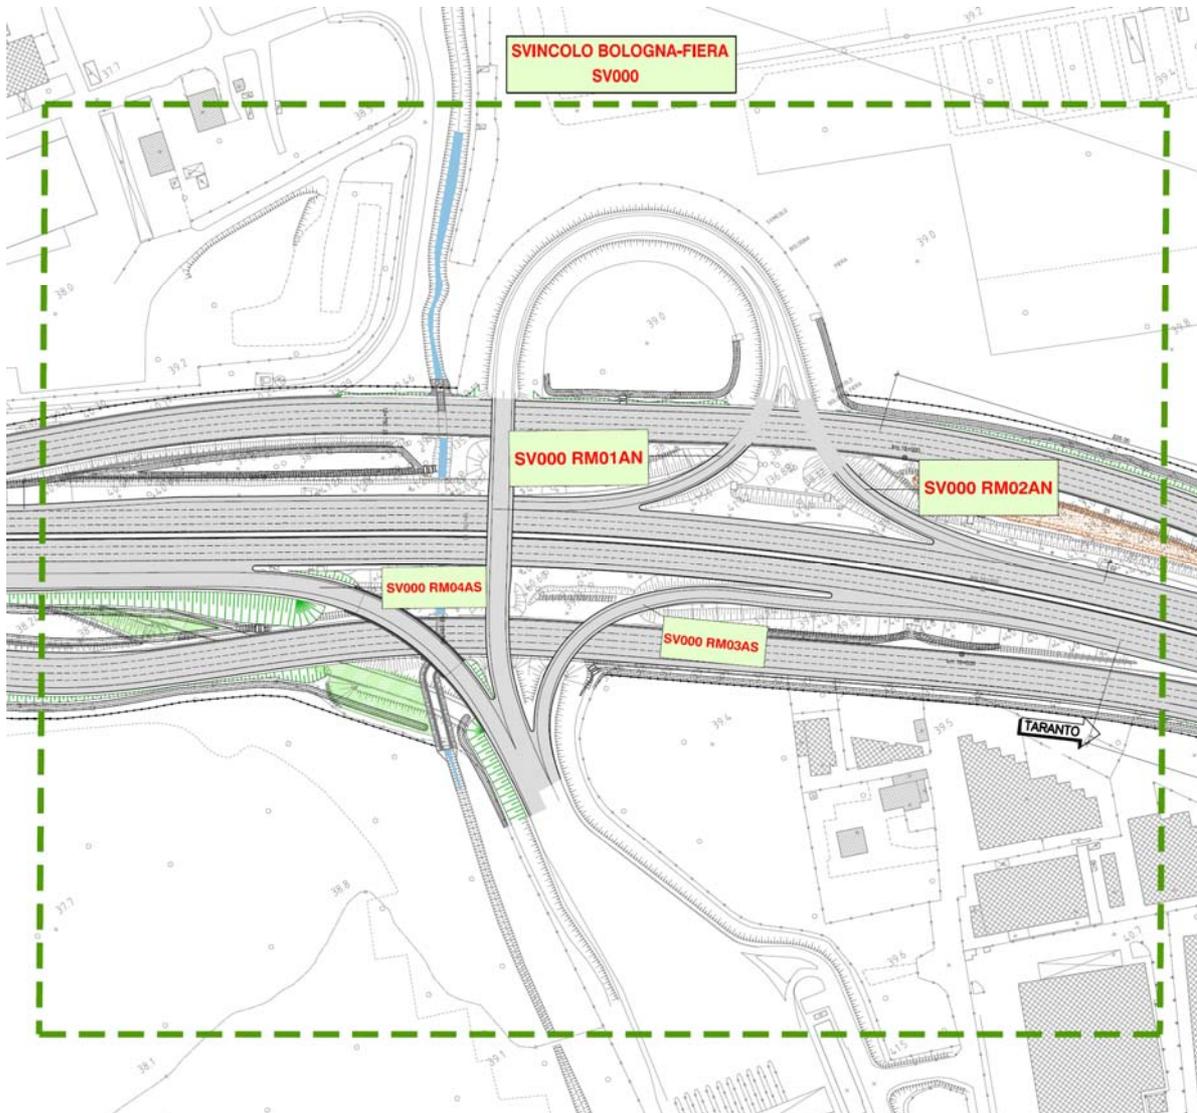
Stralcio planimetrico svincolo Bologna - Fiera
